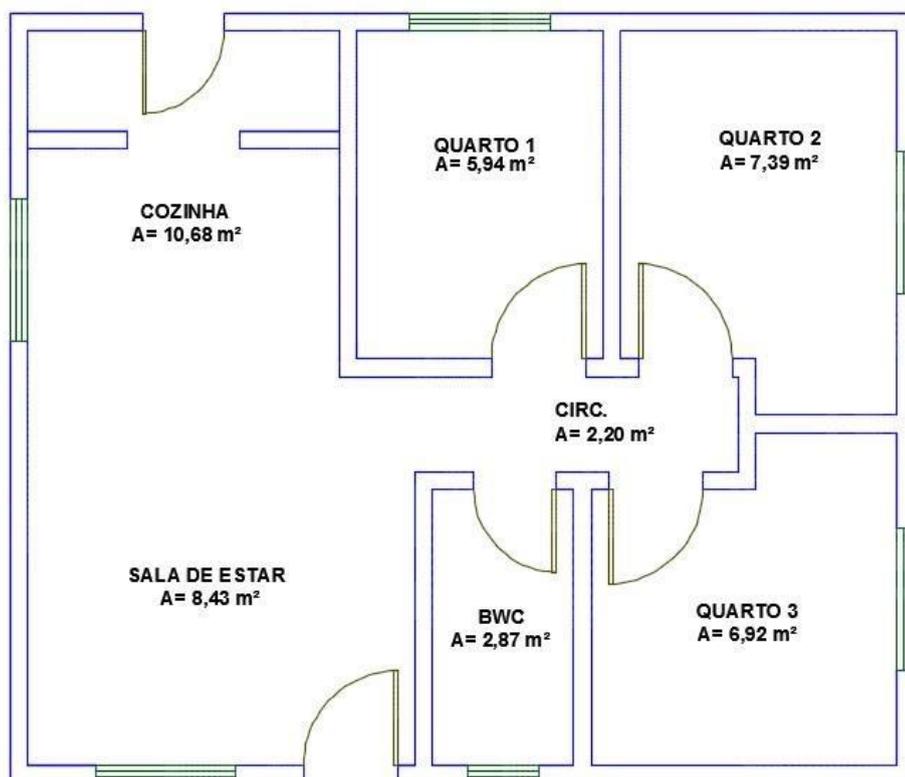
Layout da planta baixa. Fonte: ECKER E MARTINS (2014).
